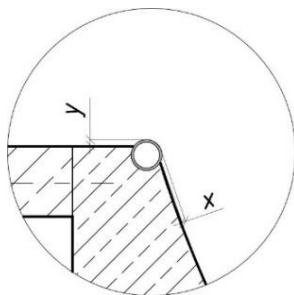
Profil równo „wtopiony” w krawędź elementu. Do profilu przyspawane marki z drutu stalowego w celu pewnego zakotwienia w betonie
